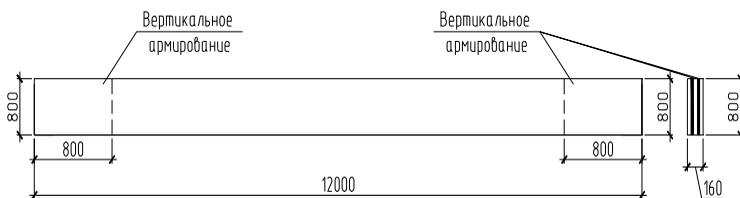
Расчетная схема балки с армированием сетками в опорной части
